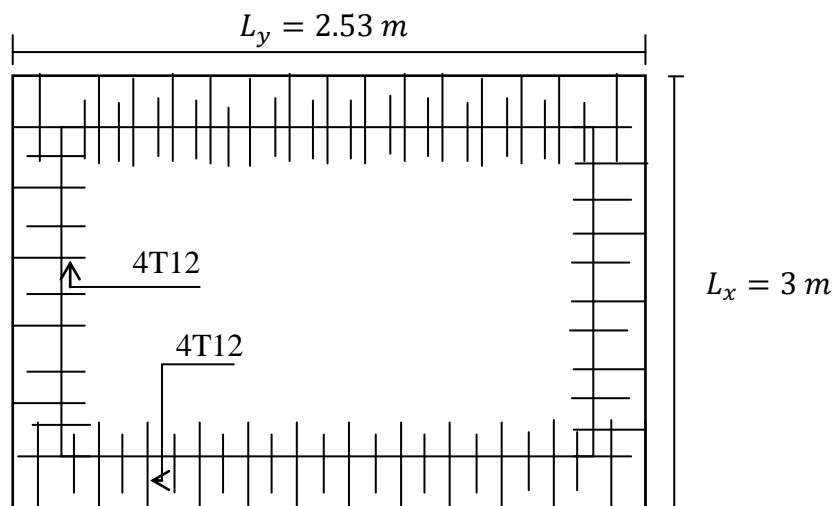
Ferrailage supérieur de la dalle de l'ascenseur,
